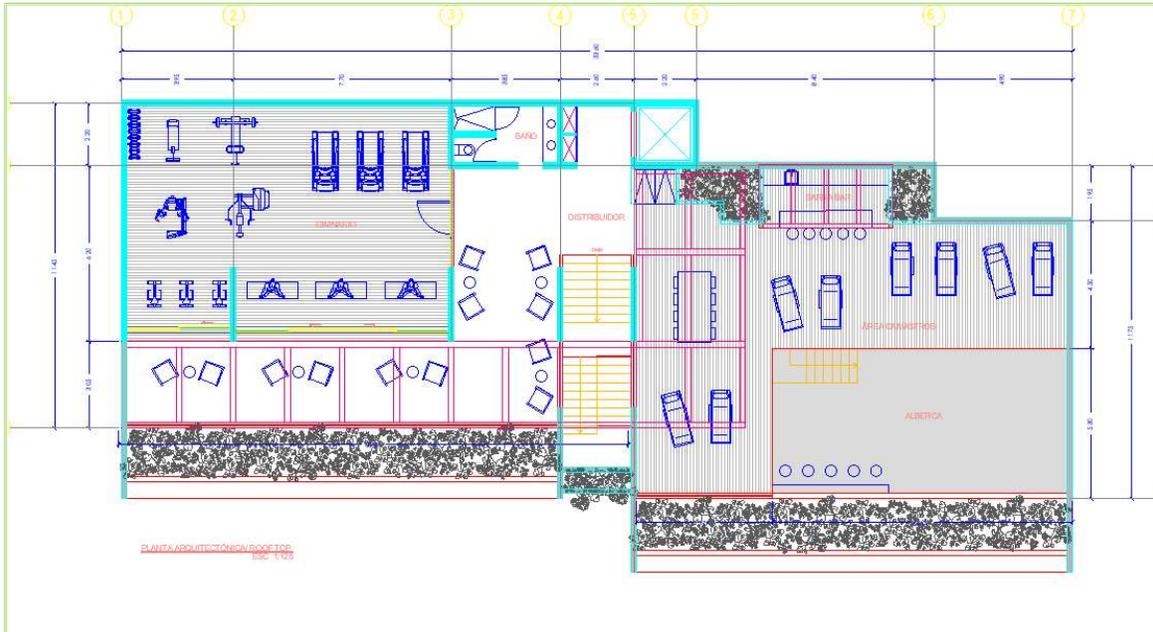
Detalle del diagrama del Roof Top nivel del Edificio B
